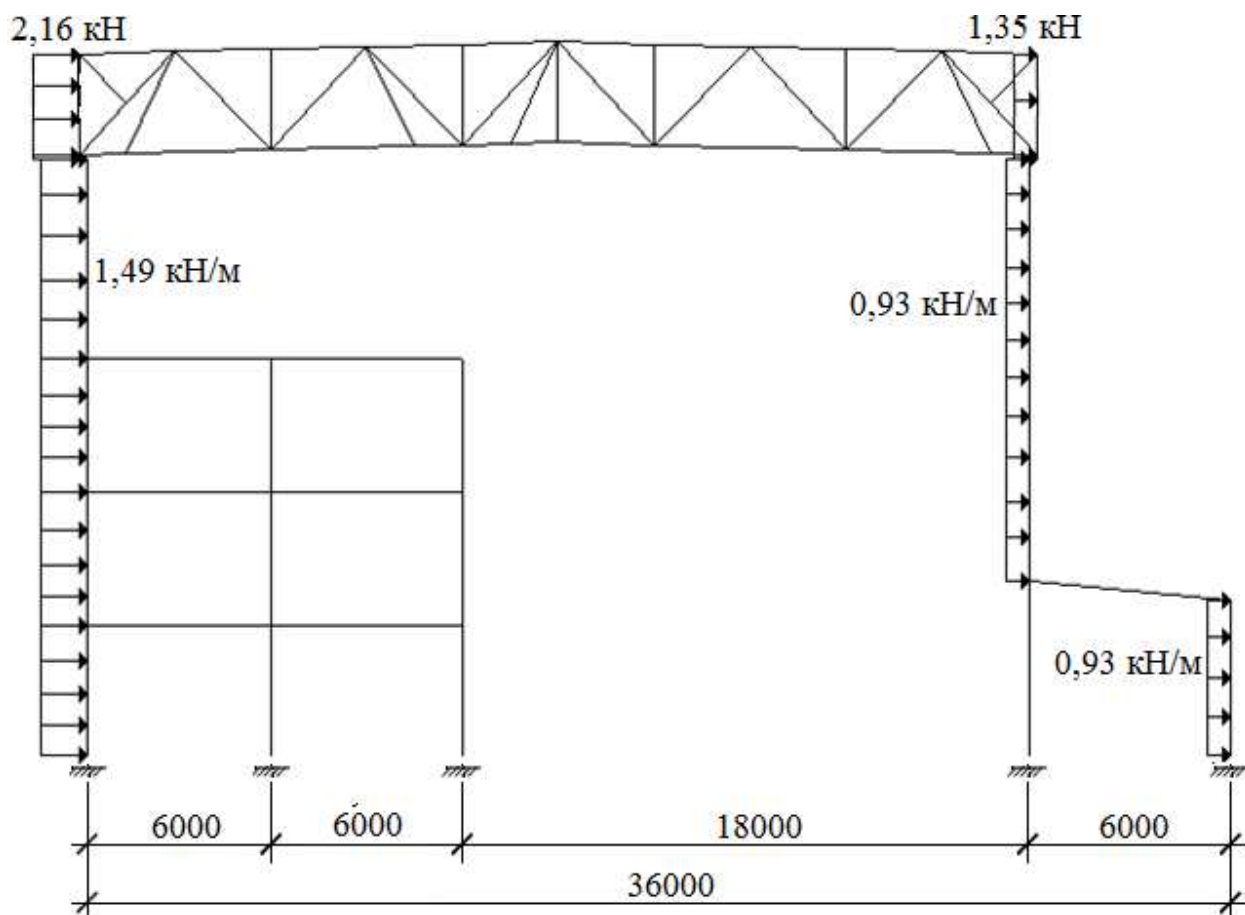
Схема загрузки от ветровой нагрузки слева здания
